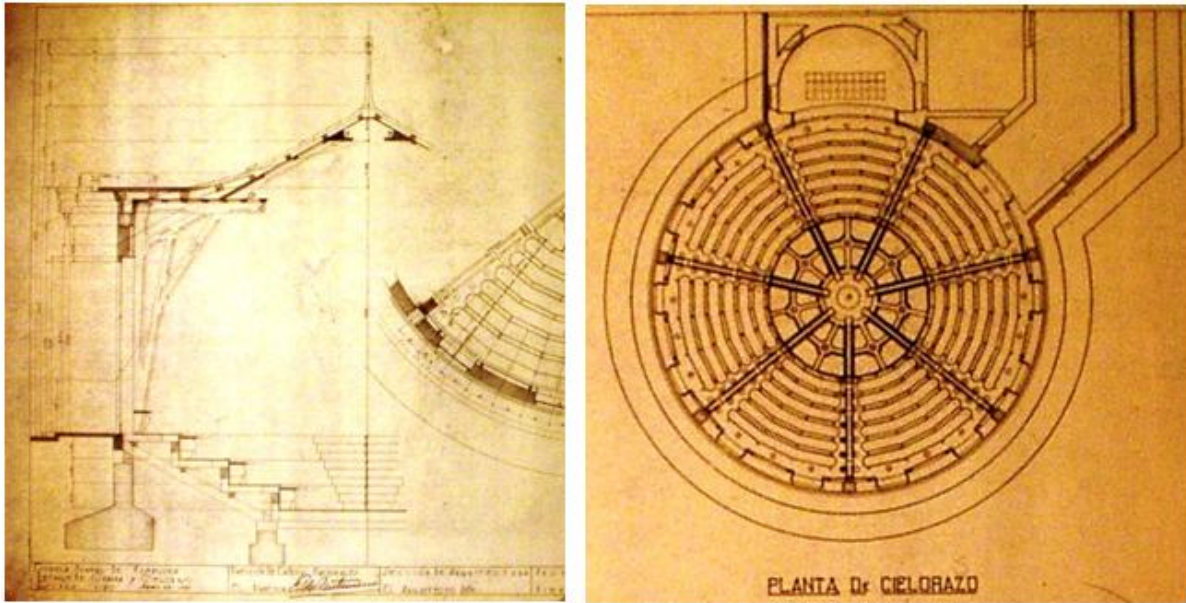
Details des Dachstuhls der Kapelle und Grundriss des Dachstuhls der Kapelle, die an die Sternkirche von Otto Bartning aus dem Jahr 1922 erinnert.
